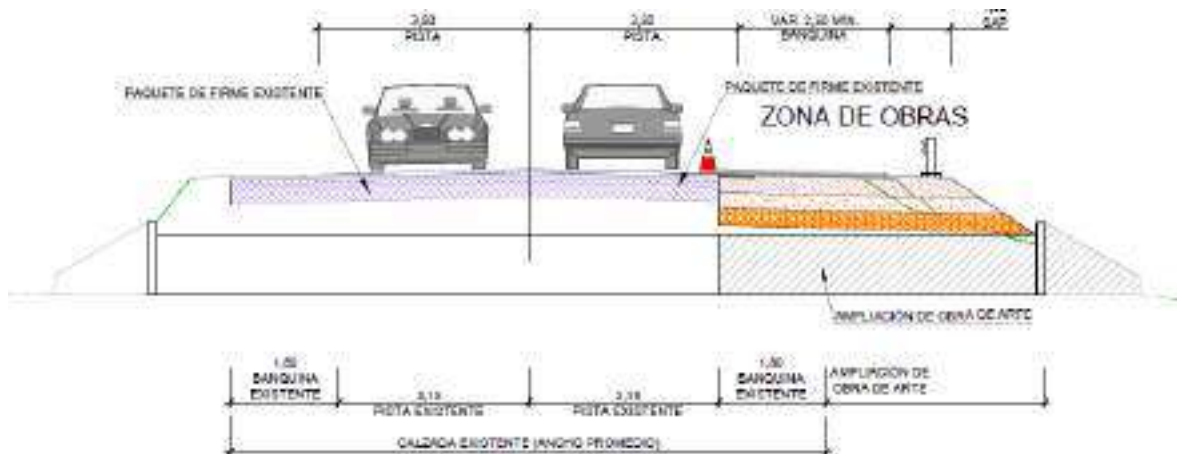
Detalle tipo para zonas de obra y tránsito en fase 1 de Desvíos Tipo III.
